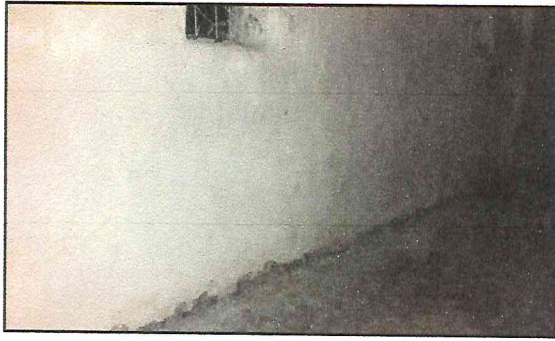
Sol en ciment. Murs en parpaings. Photo13 : Toiture formée d'une couche de gros rameaux de bois.
